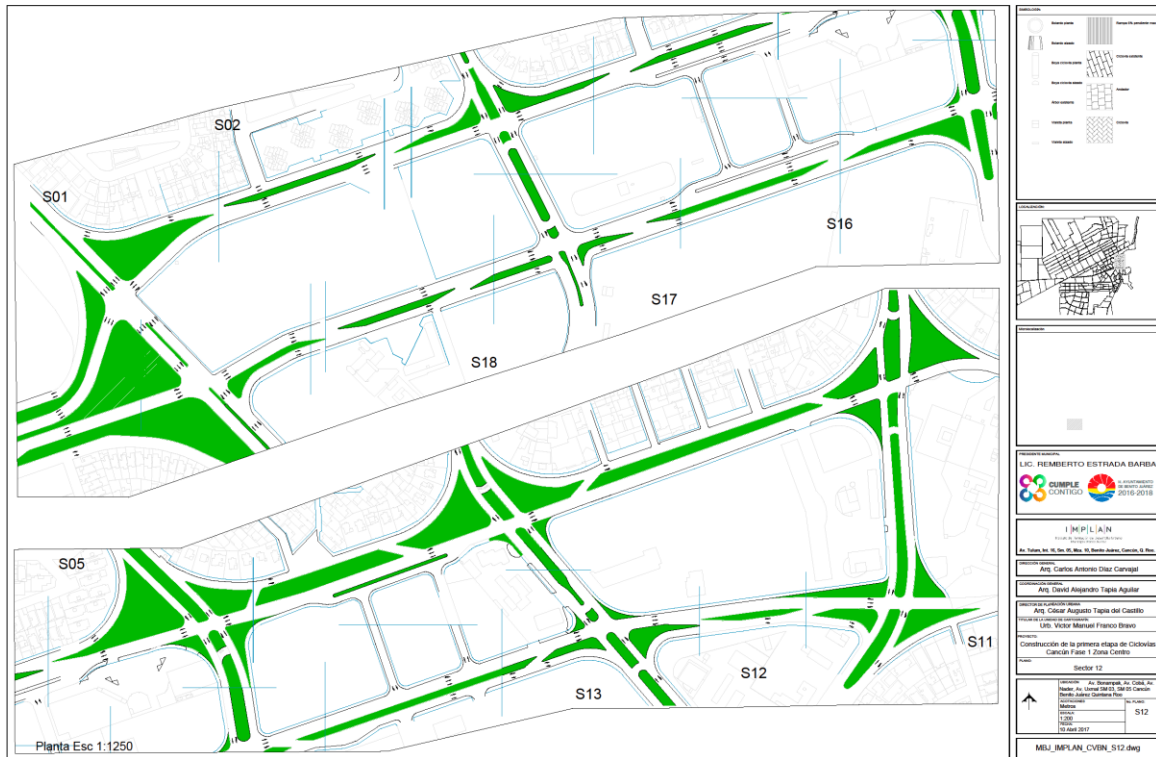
Plano del Plan Maestro del proyecto “Par Vial Av. Coba y Av. Xcaret.
